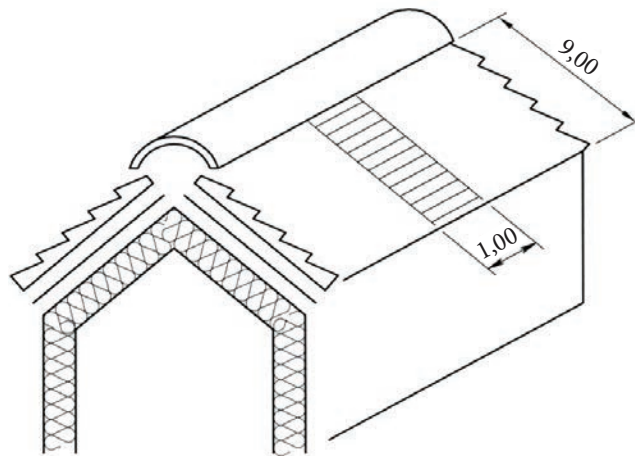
К расчету вентиляционного канала на карнизном свесе
